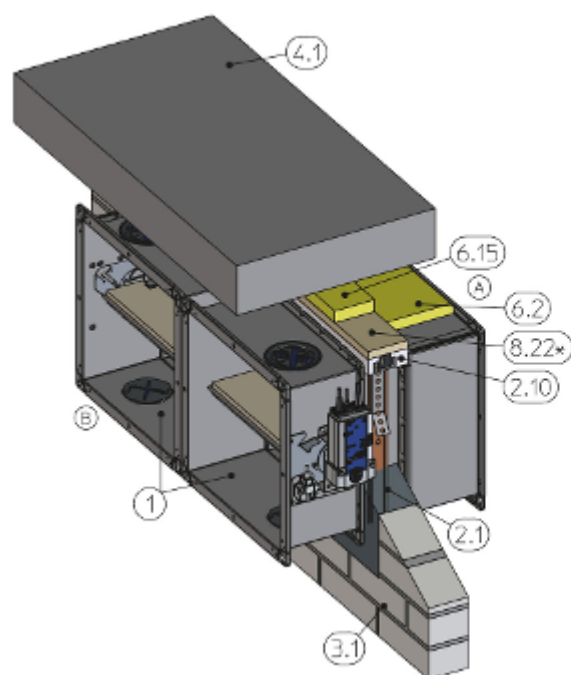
Montage à base de mortier dans un mur plein avec un joint de plafond souple, avec kit d'installation GM
